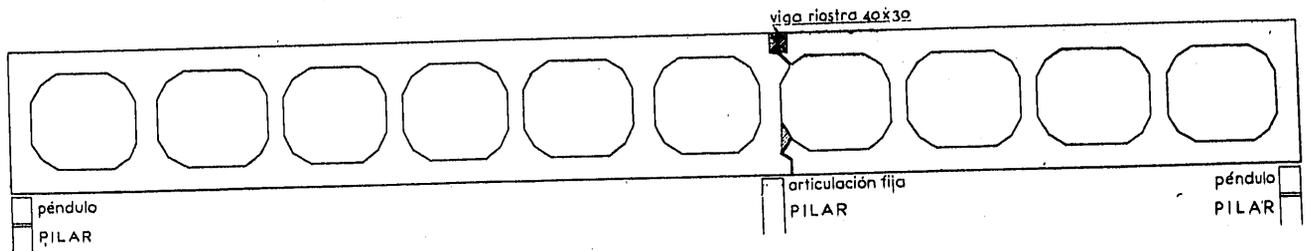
Empalme de las vigas de 15 y 10 metros.
